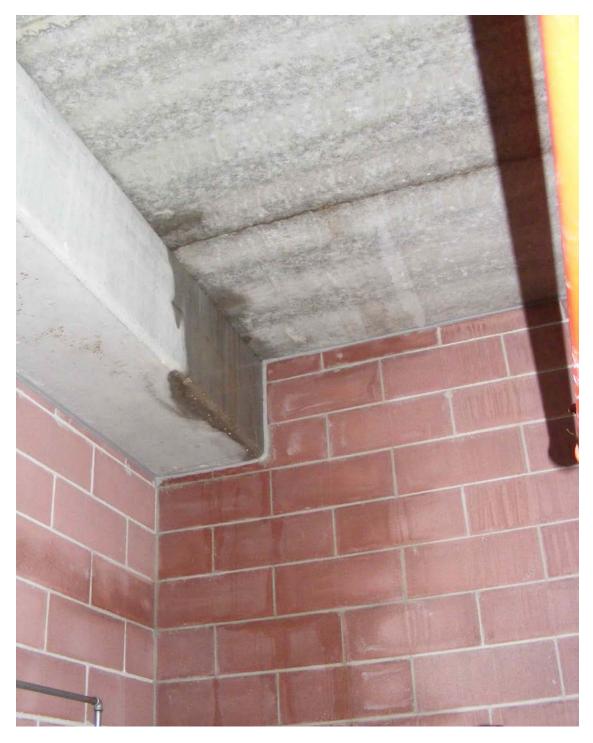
Venuta in corrispondenza dell'appoggio del solaio con infiltrazioni nel muro
